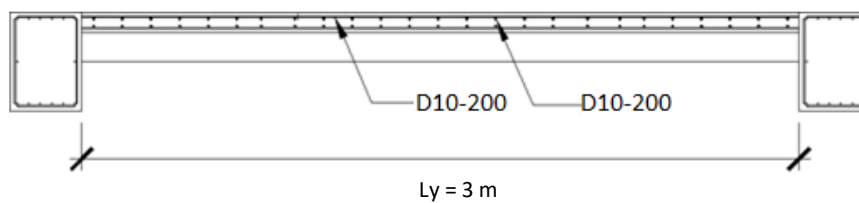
Detail Penampang Tulangan Lapangan Arah Y Plat Type A1
